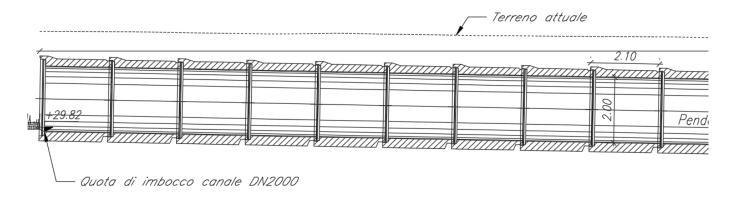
Stralcio di sezione longitudinale dello scatolare
